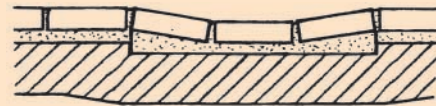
Ejemplo de pavimentado de un canal. Para la colocación del adoquín en la zona del canal se necesita un lecho de mortero (pendiente 1:3).
